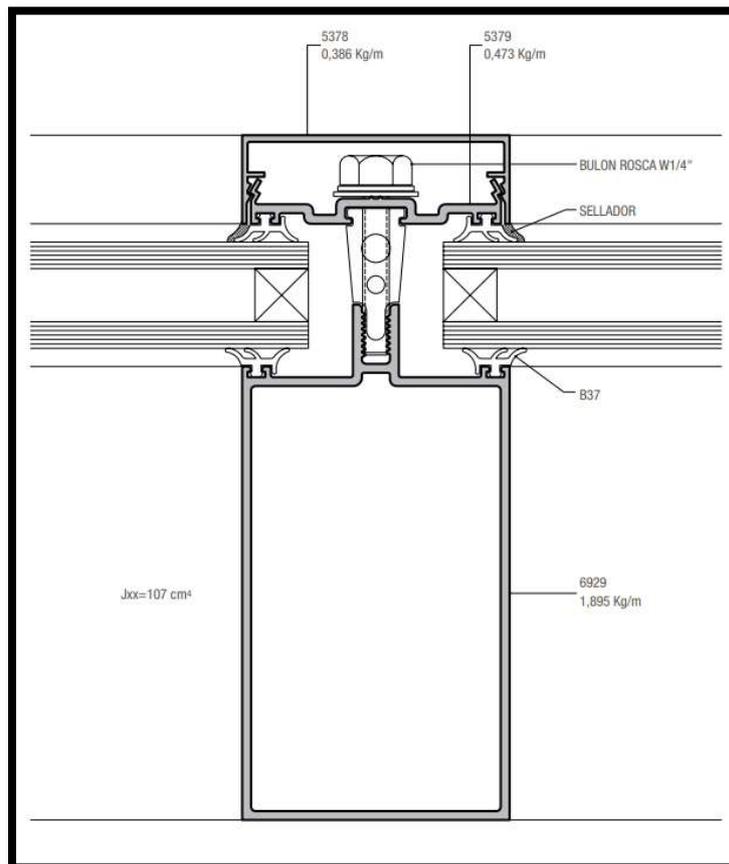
Detalle de cerramiento vidriado - Sistema Frente Integral.
